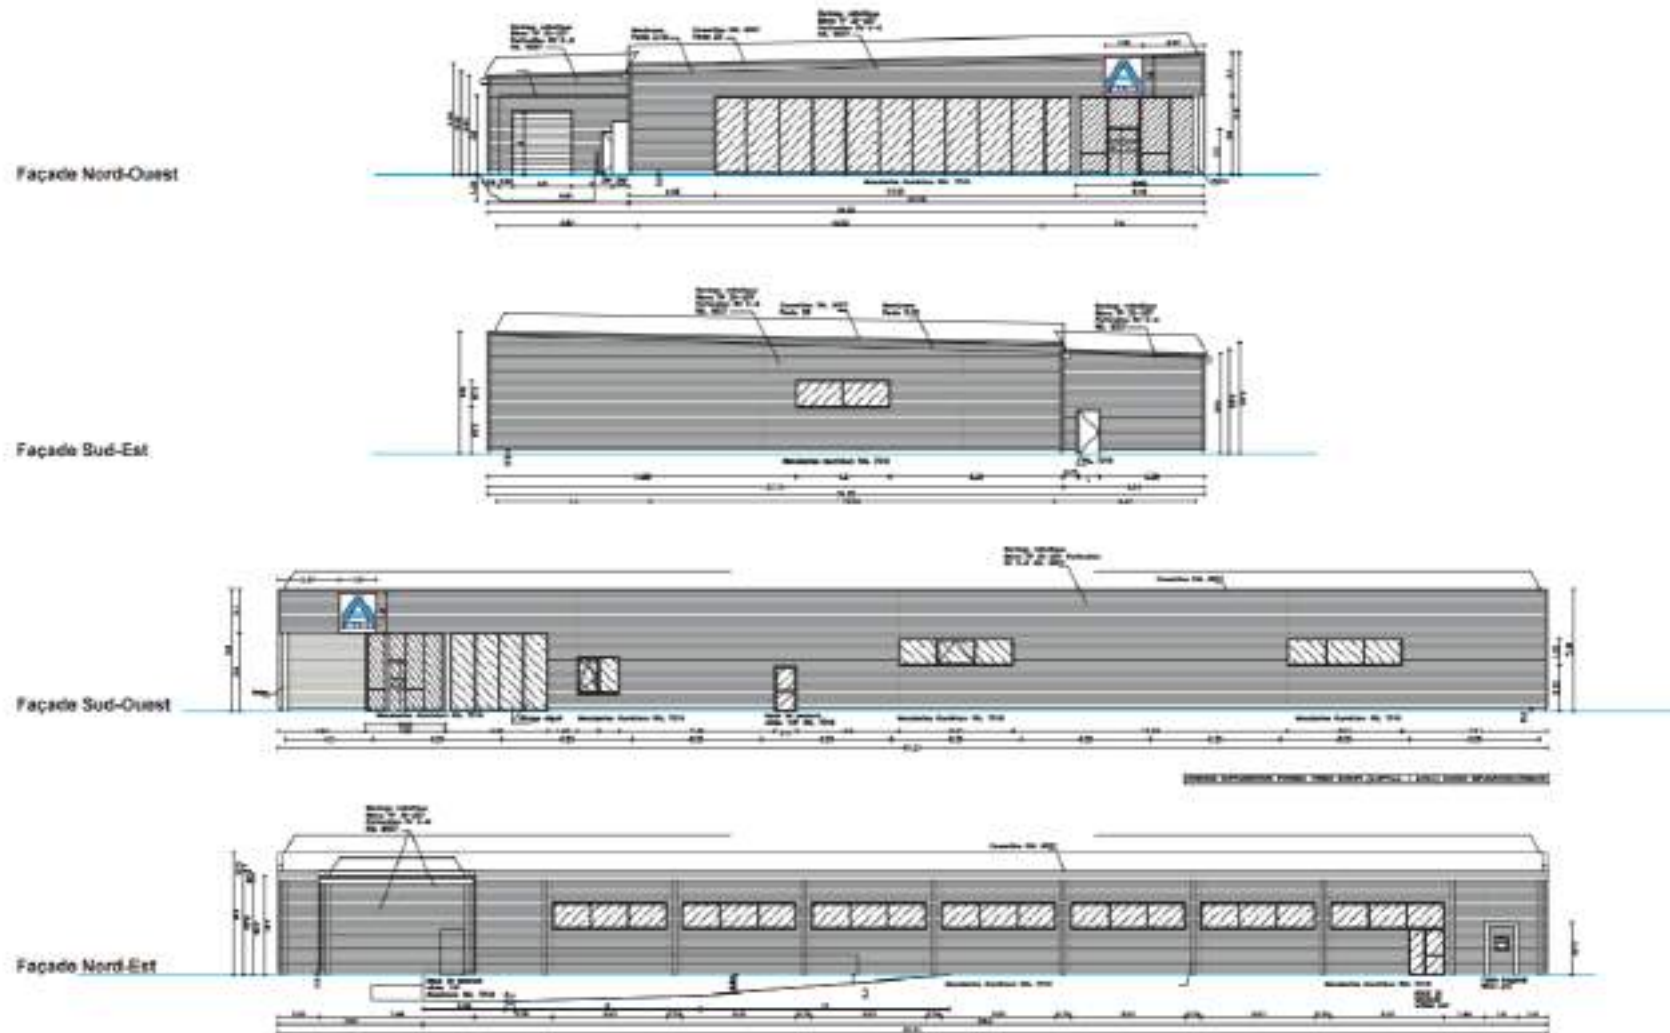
Plan en coupe du terrain et de la construction – Source : ALDI
